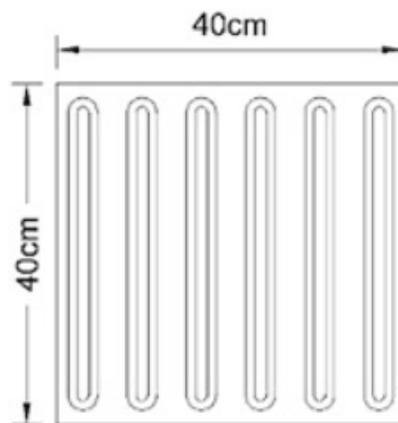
Baldosa de alerta en cambio de dirección
